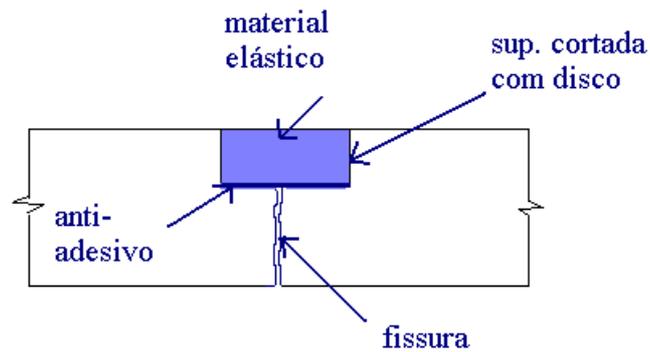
Técnica da selagem para correção das fissuras
